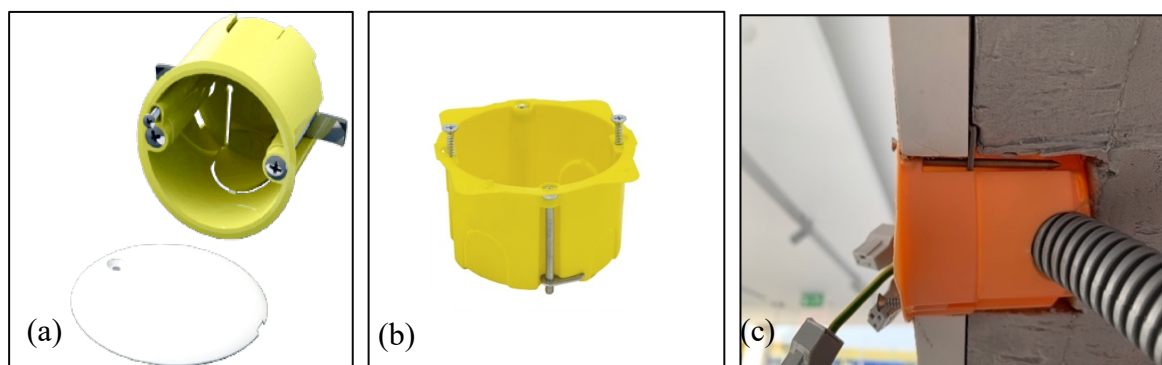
Caixas de aparelhagem para pladur: (a) Garras em posição de aberto; (b) Garras em posição fechada para instalação e (c) Caixa de aparelhagem fixa na parede através das garras de pladur.
